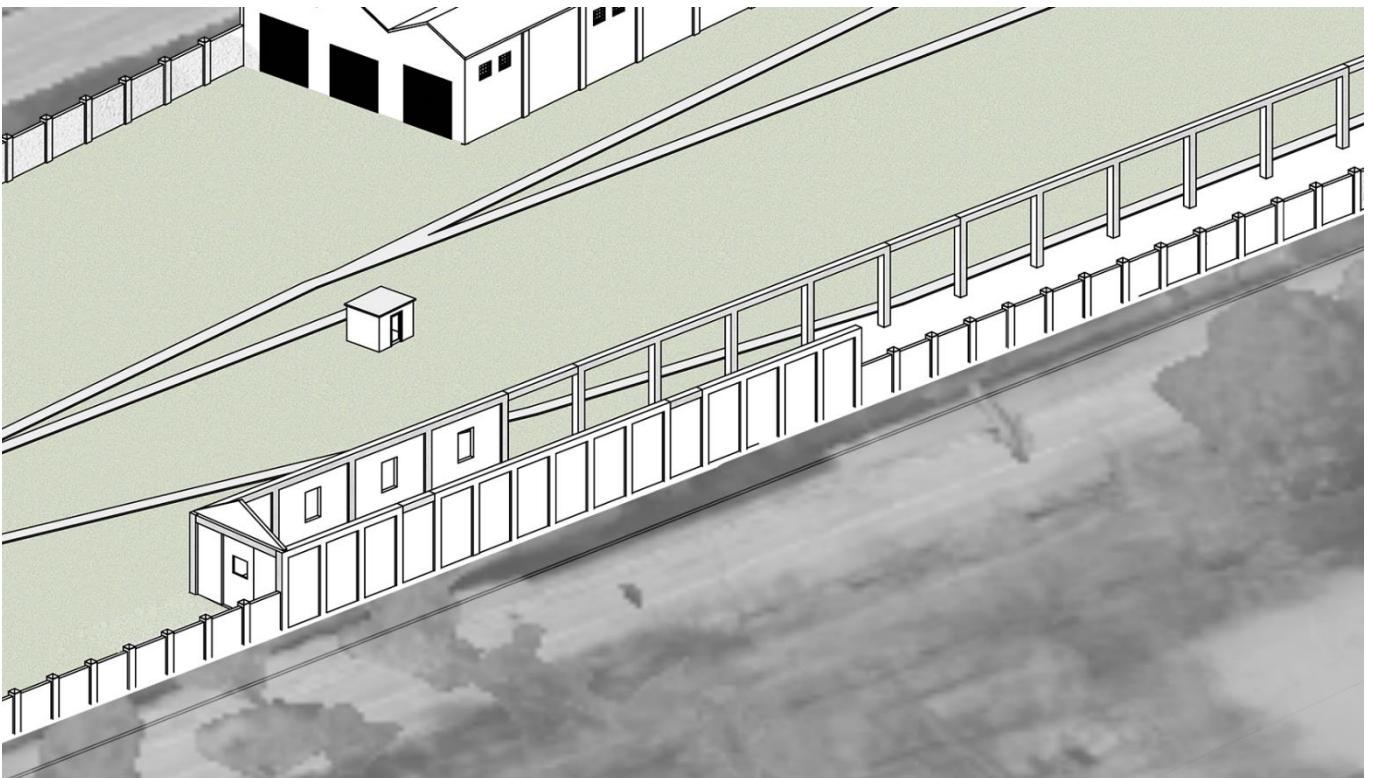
Assonometria dello stato di fatto della porzione a sud-est.
